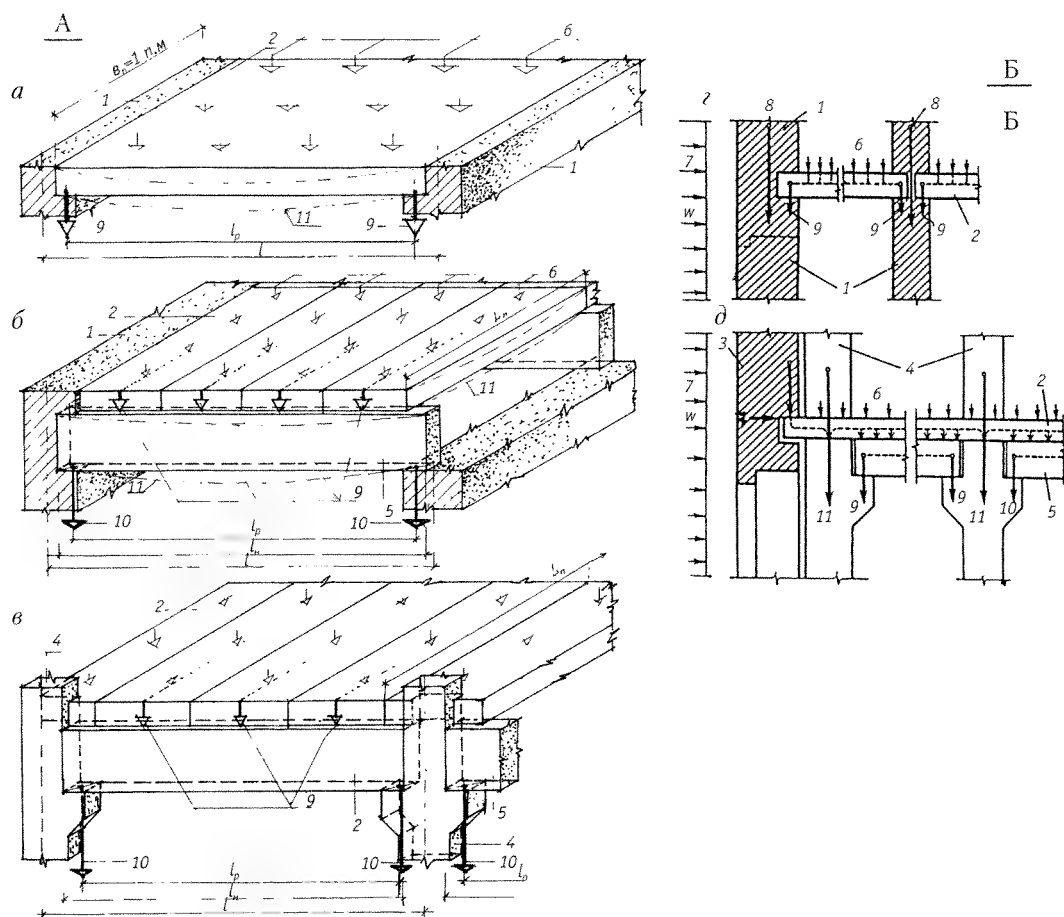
Виды нагрузок на несущие конструкции любого этажа (А); виды всех нагрузок на вертикальные опоры (Б):
